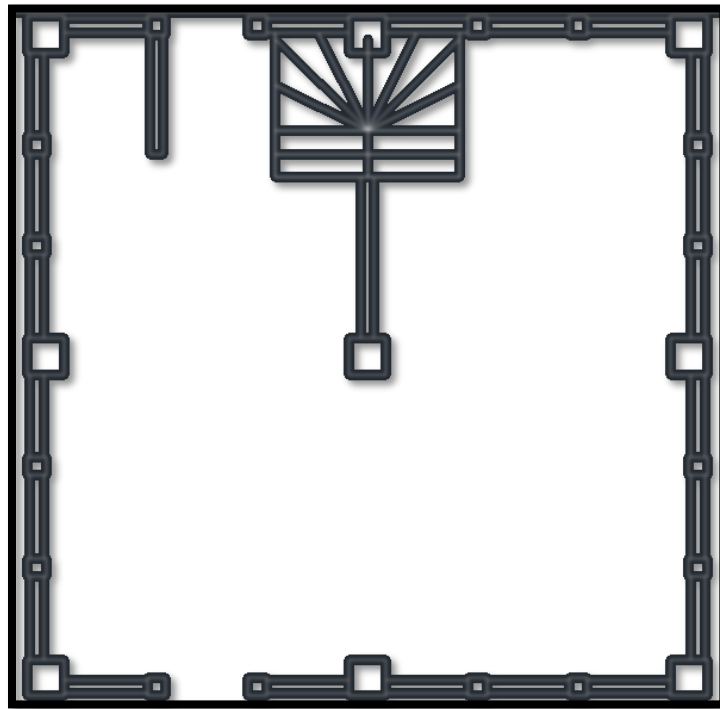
Ubicación de zócalos y sobre cimientos (Planta baja).
